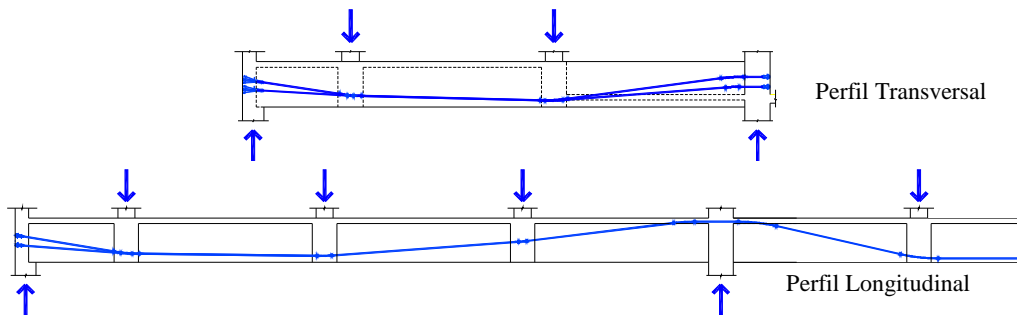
Traçado tipo do pré-esforço das vigas pré-esforçadas da estrutura de transição
